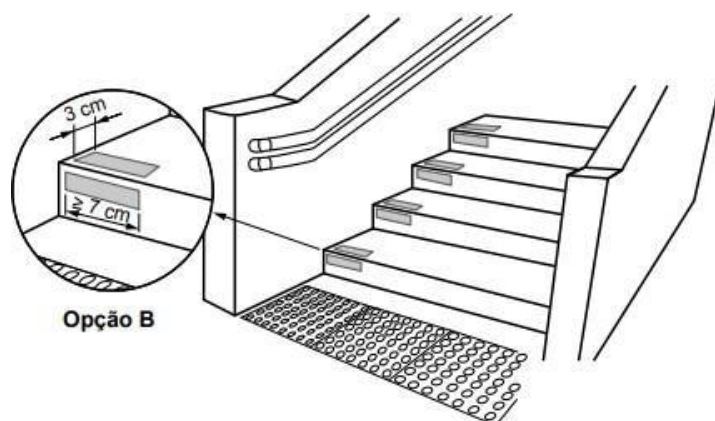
Opção B da aplicação de sinalização em degraus de escadas, dimensões em centímetros.
